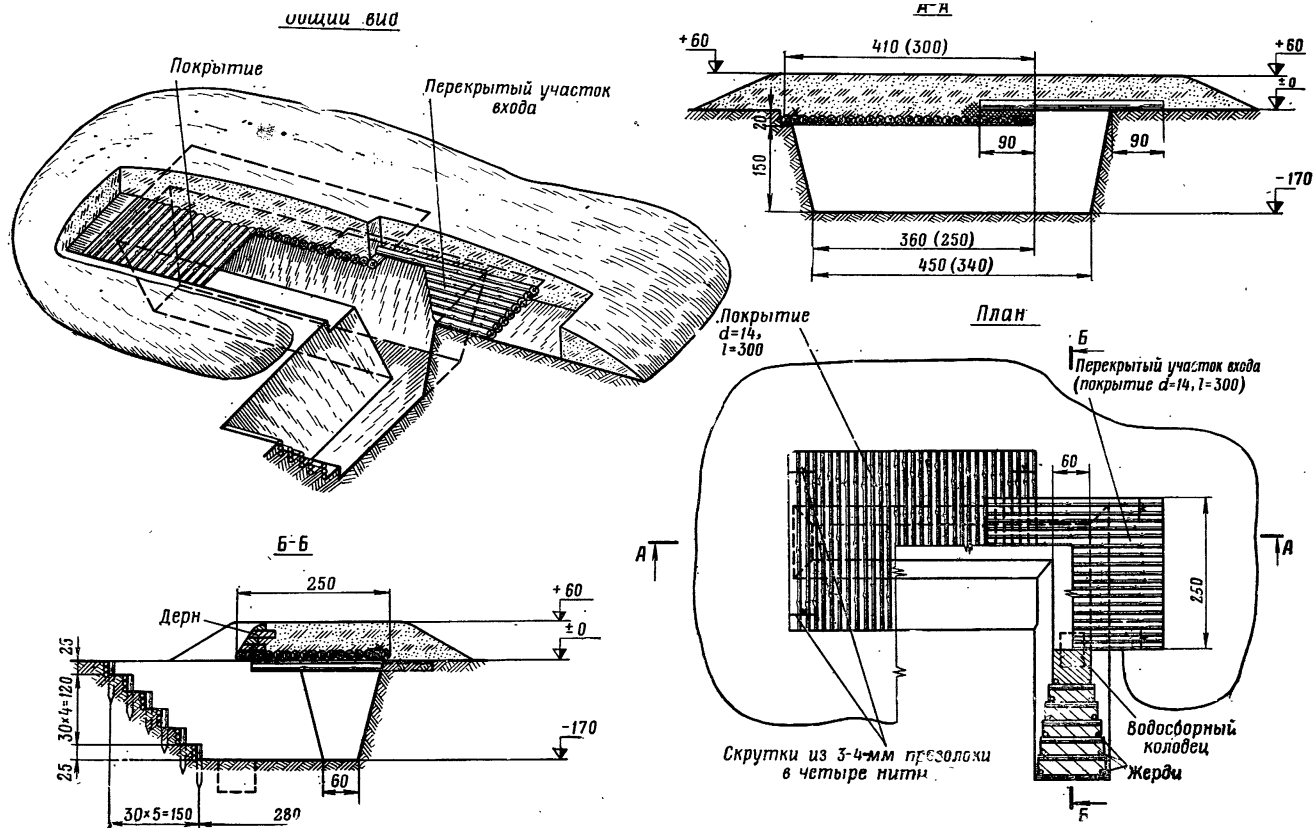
Перекрытая щель на отделение (расчет, экипаж)
